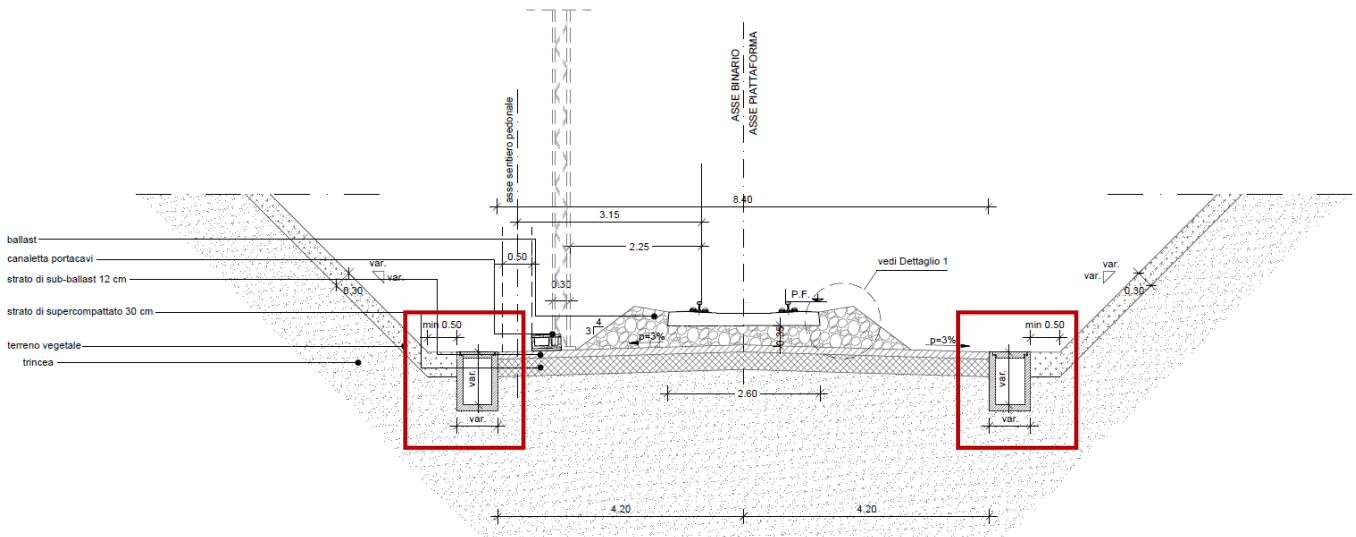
Sezione tipo piattaforma ferroviaria in trincea; in rosso le canalette a sezione rettangolare di difesa idraulica.
